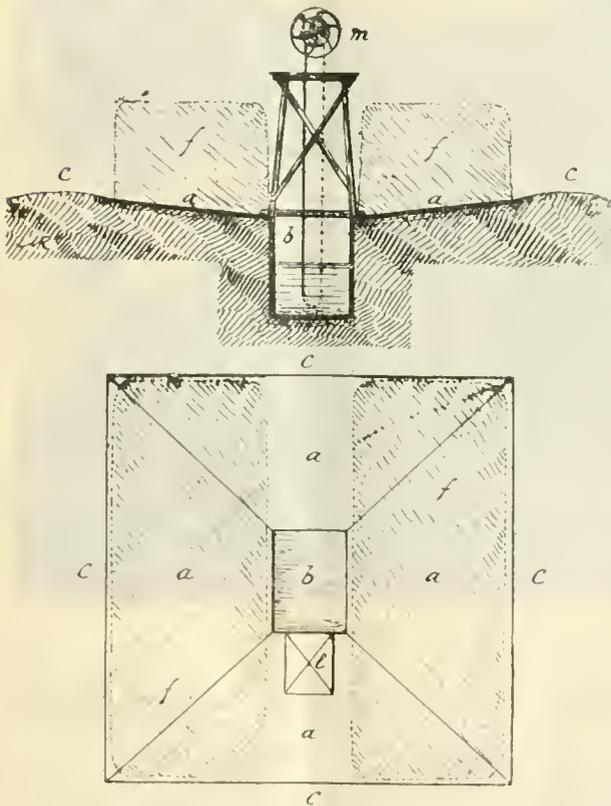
Elévation-coupe et plan d'une plate-forme à fumier concave.
